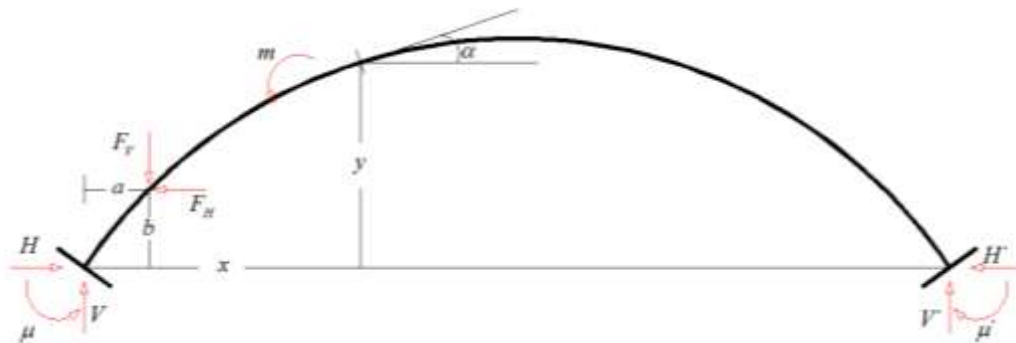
Arco biempotrado, reacciones de apoyo. (Fuente: Formulario para proyectos de puentes de arco de hormigón armado, autor: Carlos Fernández Casado)
